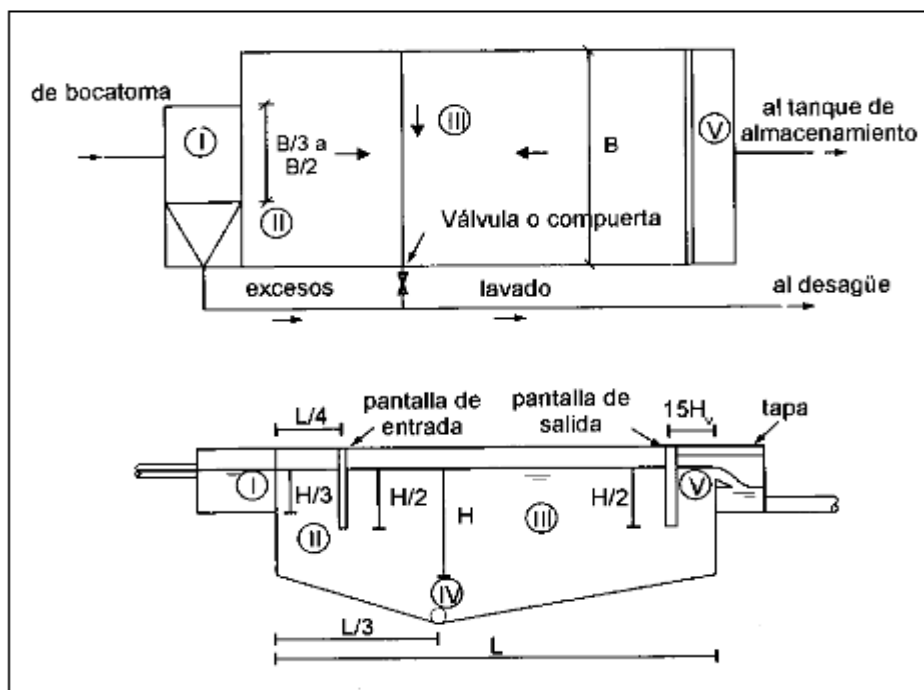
Planta y corte longitudinal del desarenador (2 pendientes)
